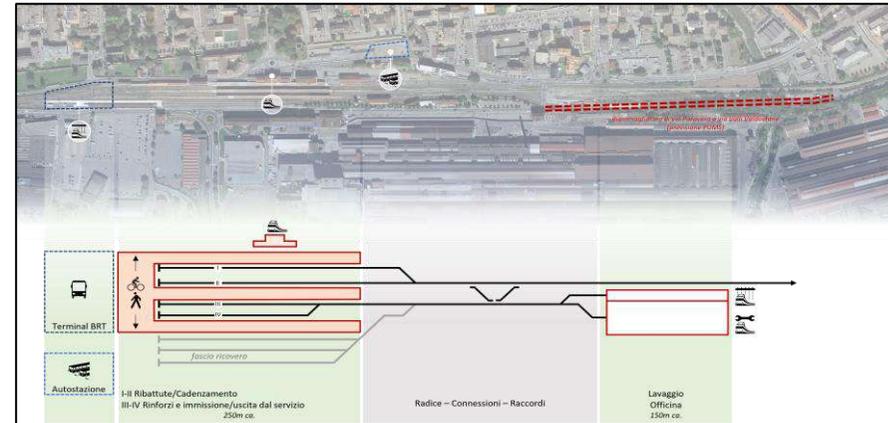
Schema Nuovo Piano del Ferro della stazione di Aosta
